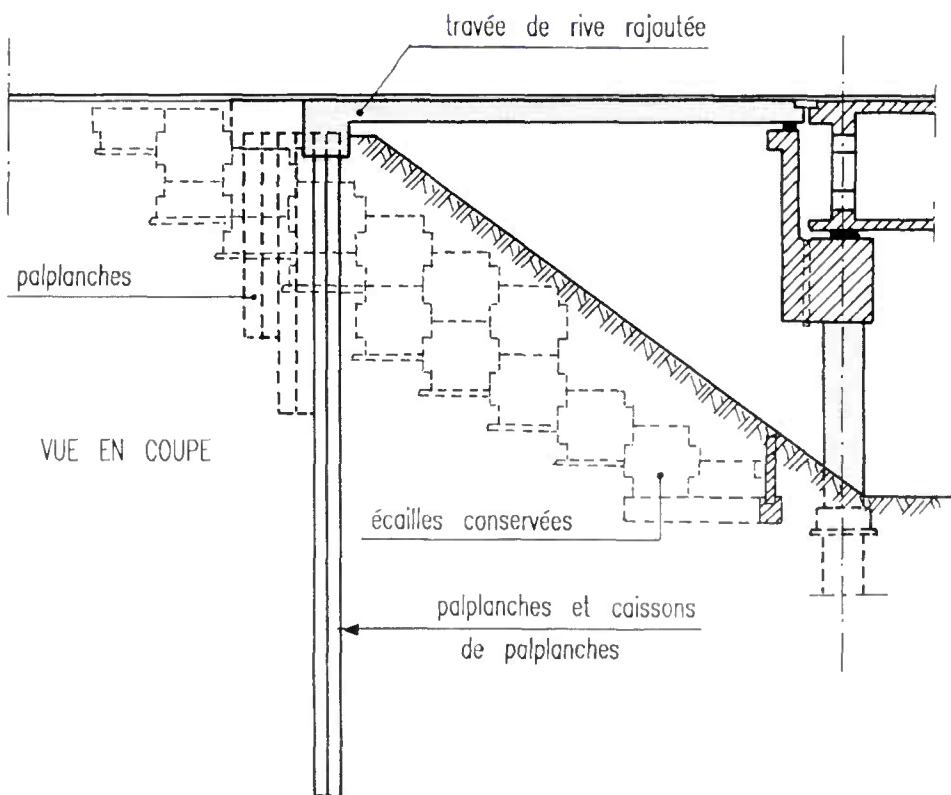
Renforcement d'une culée par rideaux de palplanches
